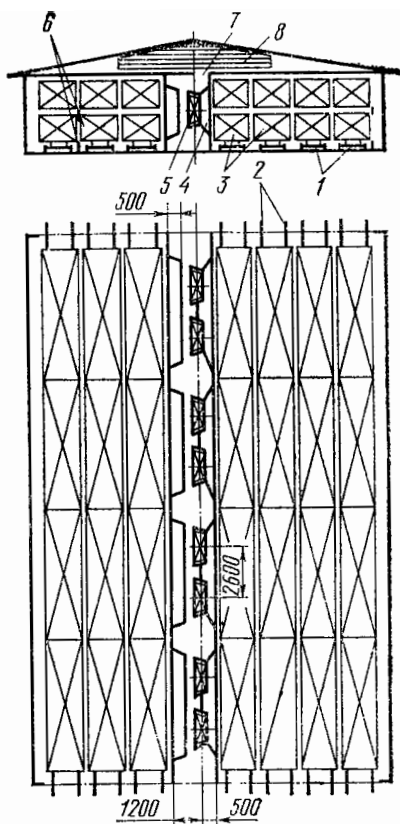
Схема вентиляторной установки непрерывного действия с продольной загрузкой штабелей (ЦНИИМОД):
